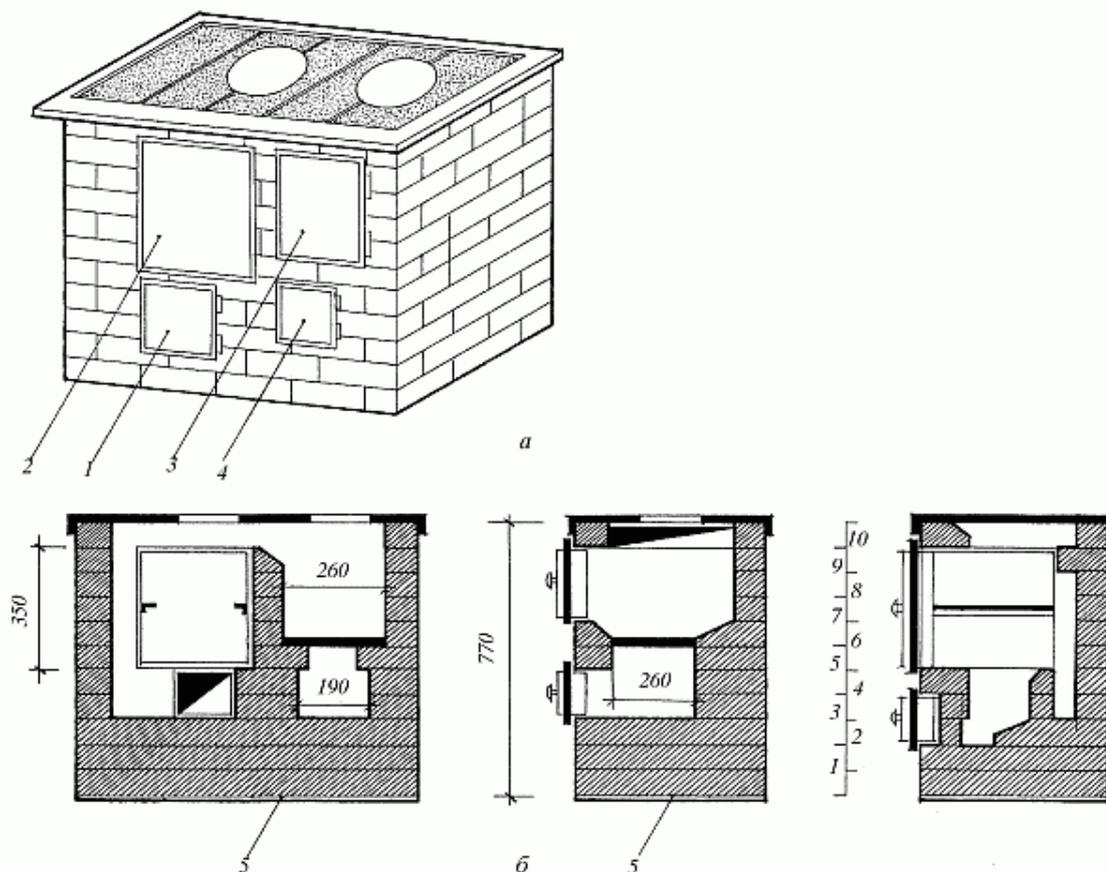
Кухонная плита с духовым шкафом: а – внешний вид; б – плита в трех разрезах; 1 – чистка; 2 – духовой шкаф; 3 – топливник; 4 – поддувало; 5 – войлок, покрытый кровельной сталью
